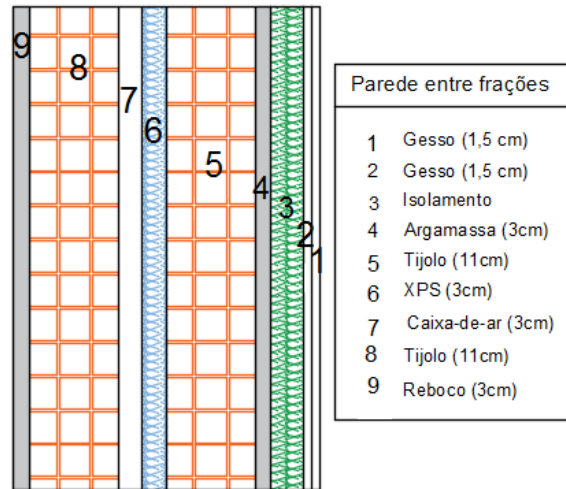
Pormenor e constituintes da parede entre frações da solução de reabilitação 2
